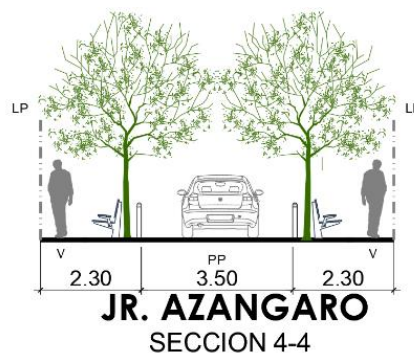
Sección Vial propuesta de Jr. Azángaro. Fuente: Propia.
